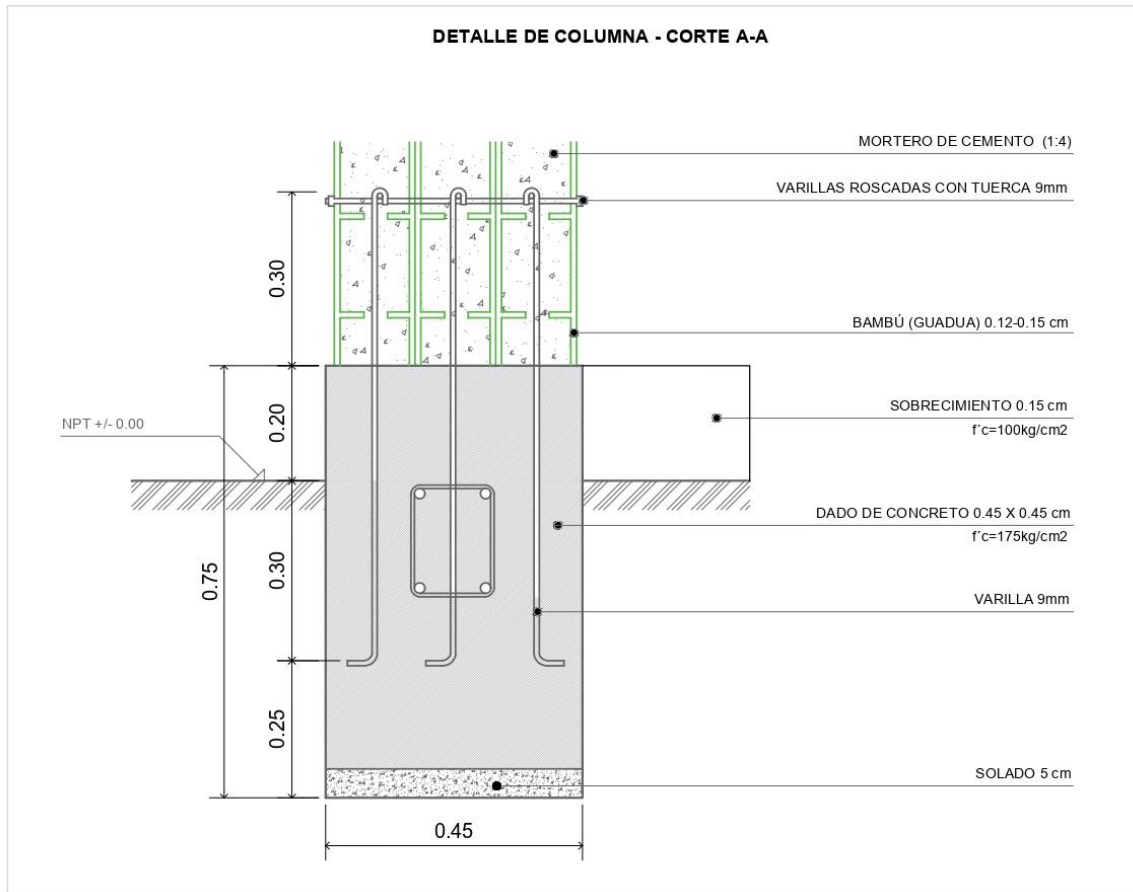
Detalle constructivo de columna, corte. Fuente: El autor
